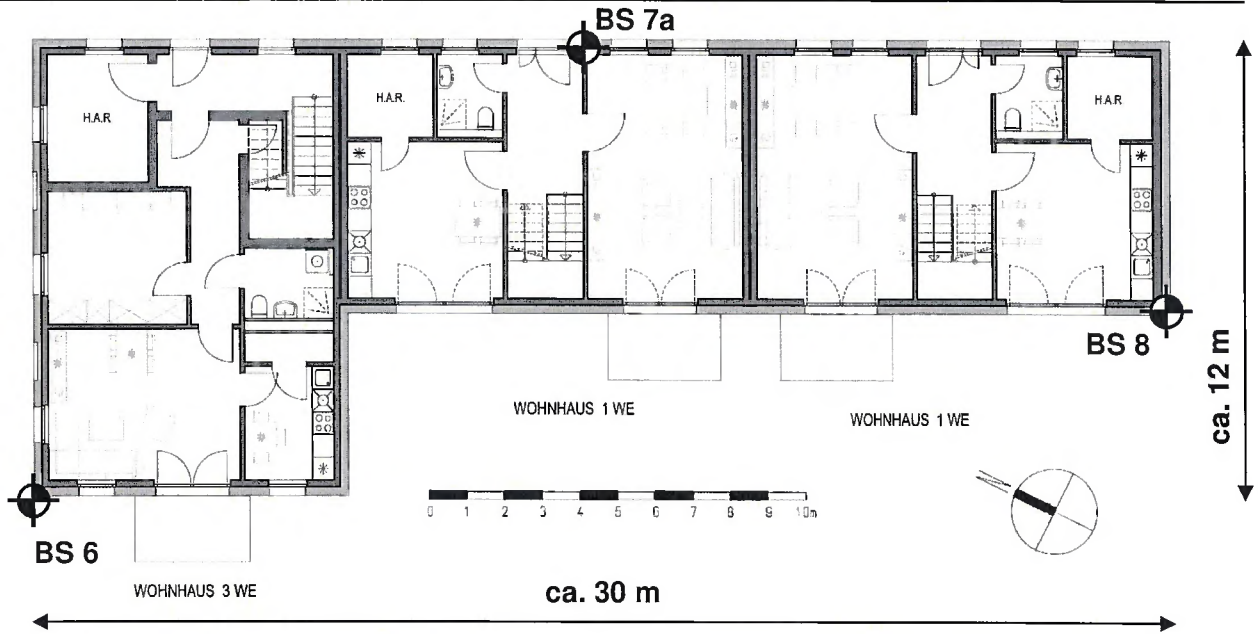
Erdgeschossgrundriss Haus 5, M 1:200
